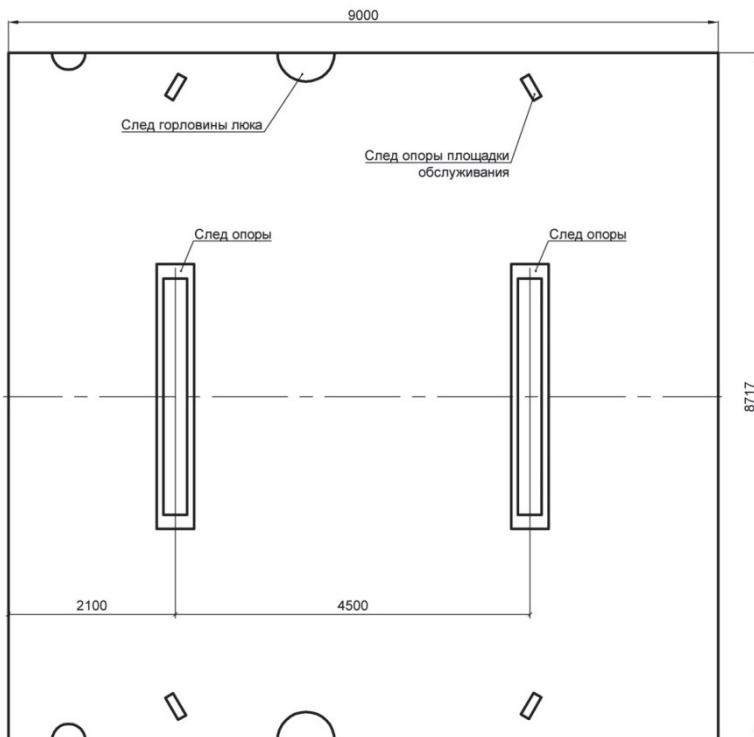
Развертка резервуара, подготовленная для раскладки нагревательной секции.
